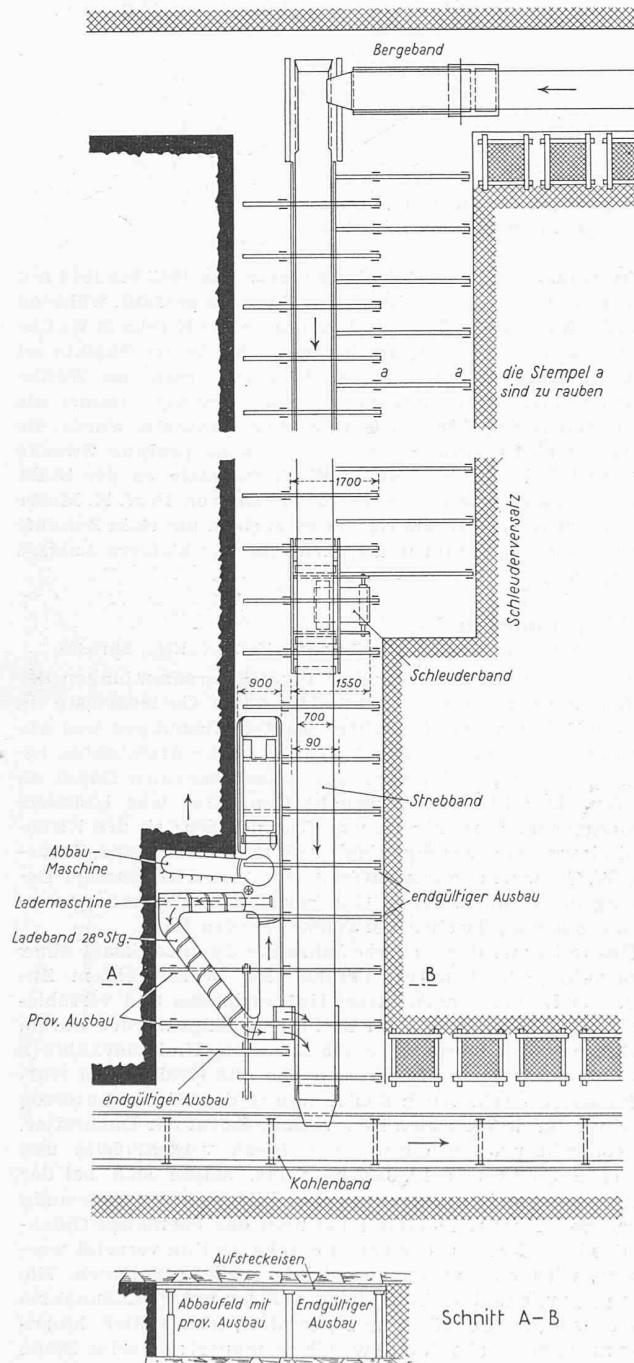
Abbauplan für Gewinnungsmaschine mit Dreiecklader
